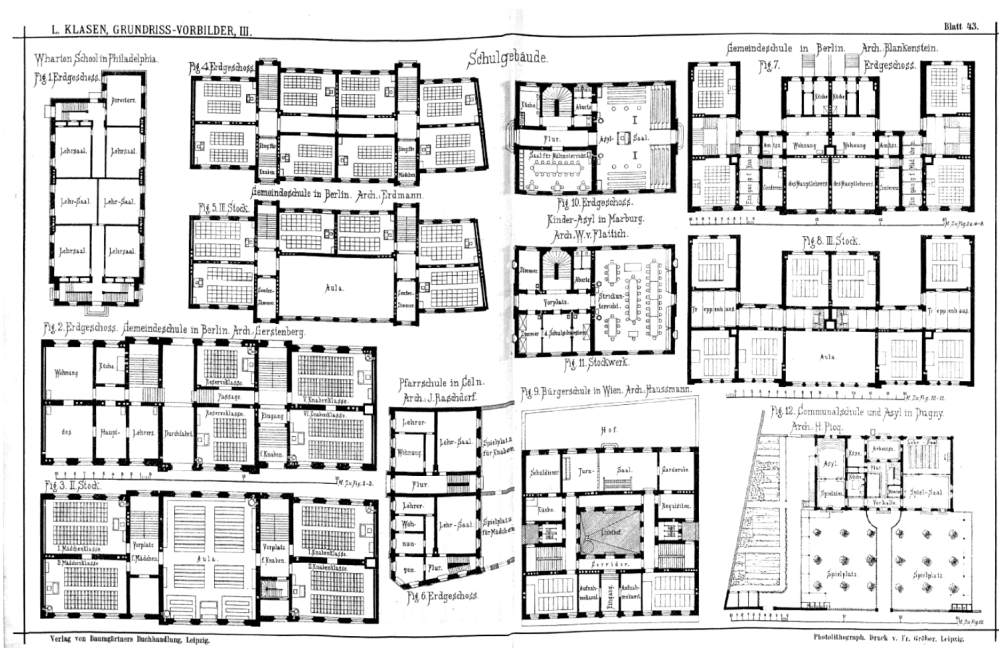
Grundriss-Vorbilder, Blatt 43 (Klassen 1884)²⁸
